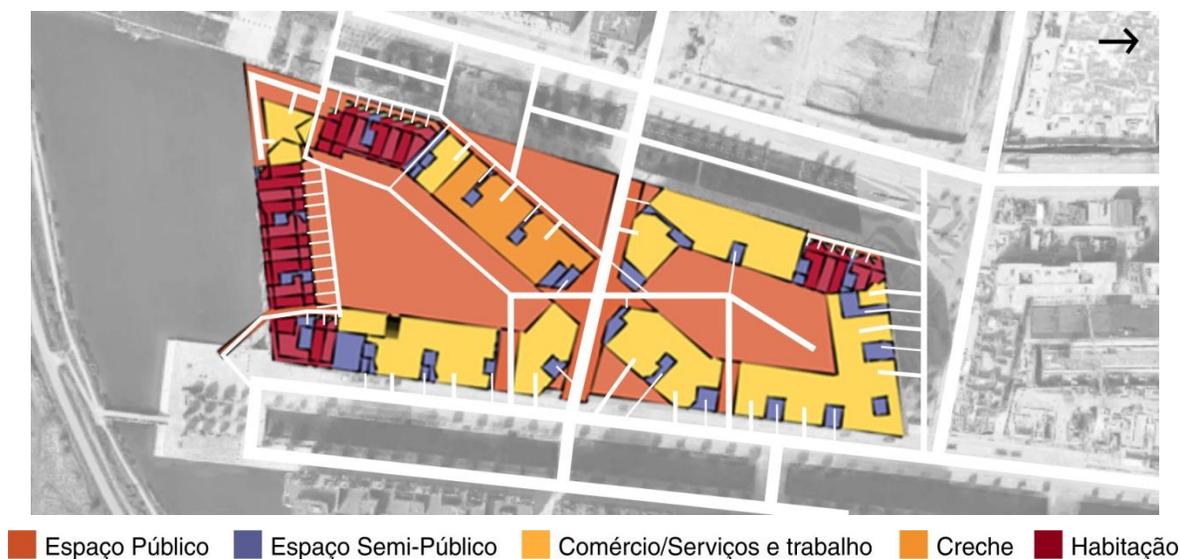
| 8 House - Pavimento Térreo | Desenho da Autora
